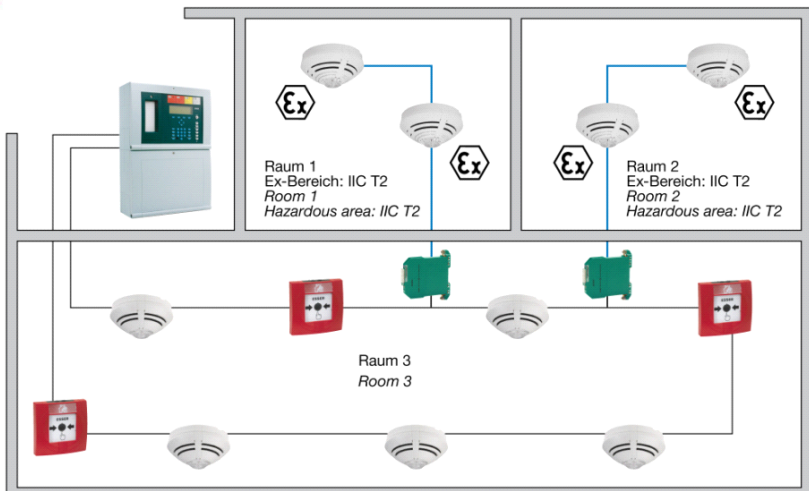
Prinzipschaltung der Ex-Barriere (Art.-Nr. 804744)
